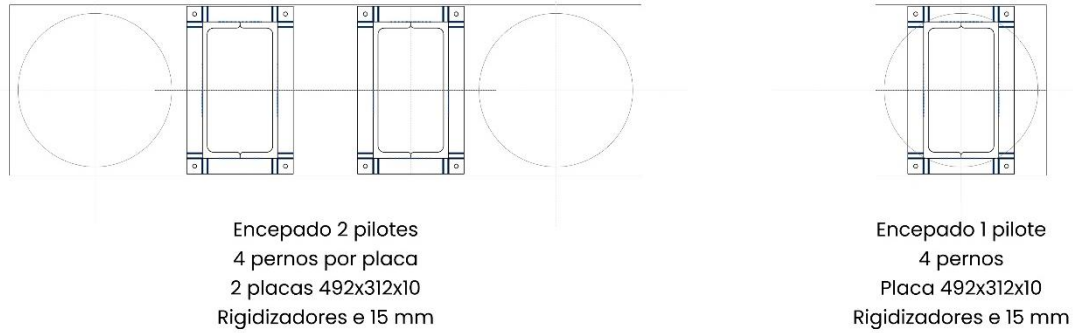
Placas, tornillos y soldaduras. Uniones de pilar metálico con encepado de pilotes
